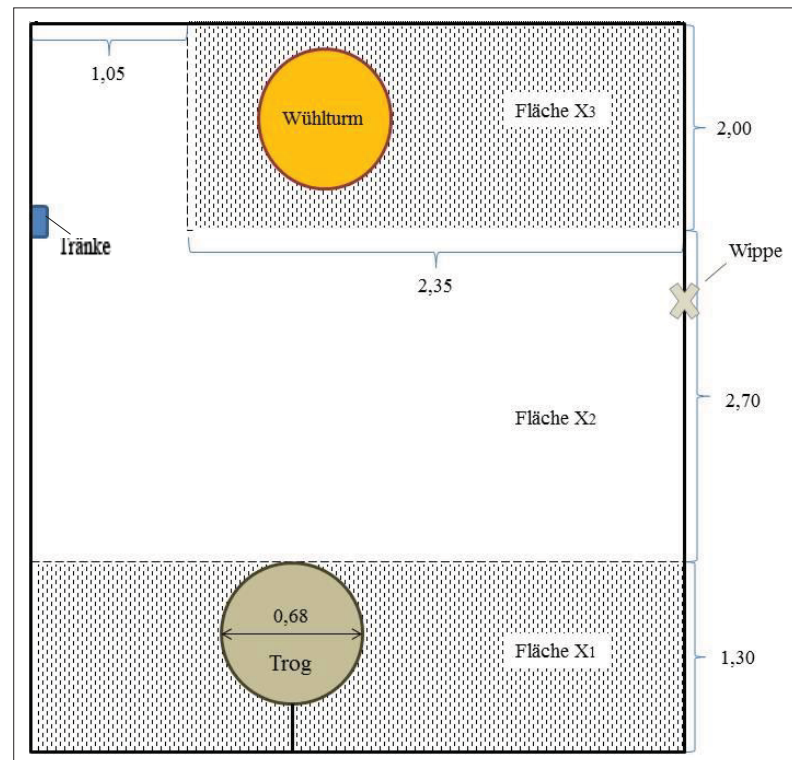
Zweiflächenbucht Mast (Laufbereiche X1 und X3 Gussroste; Liegebereich X2 mit drainierten Betonelementen)
